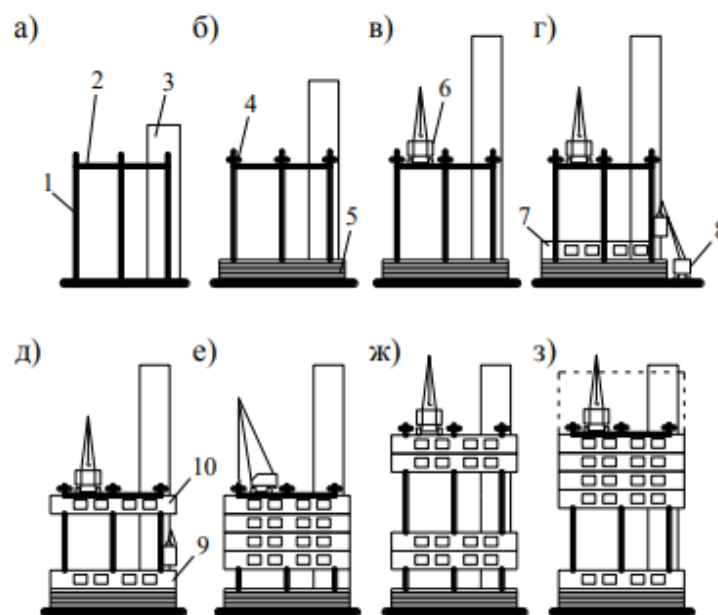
Схема монтажу будинку методом підйому поверхів: а – зведення сходинокві - ліфтової шахти та колон; б – виготовлення плит перекриття; в – підйом плити покриття; г – монтаж конструкцій поверху; д – підйом змонтованого поверху; е – нарощування колон; ж, з – підйом наступних поверхів; 1 – колони; 2 – монтажні зв'язки; 3 – сходинокві-ліфтова шахта; 4 – підйомник; 5 – пакет плит перекриття; 6 – кран для монтажу колон; 7 – поверх, що монтується; 8 – кран для монтажу стін та перегородок; 9 – змонтований поверх; 10 – поверх у проміжному стані .
